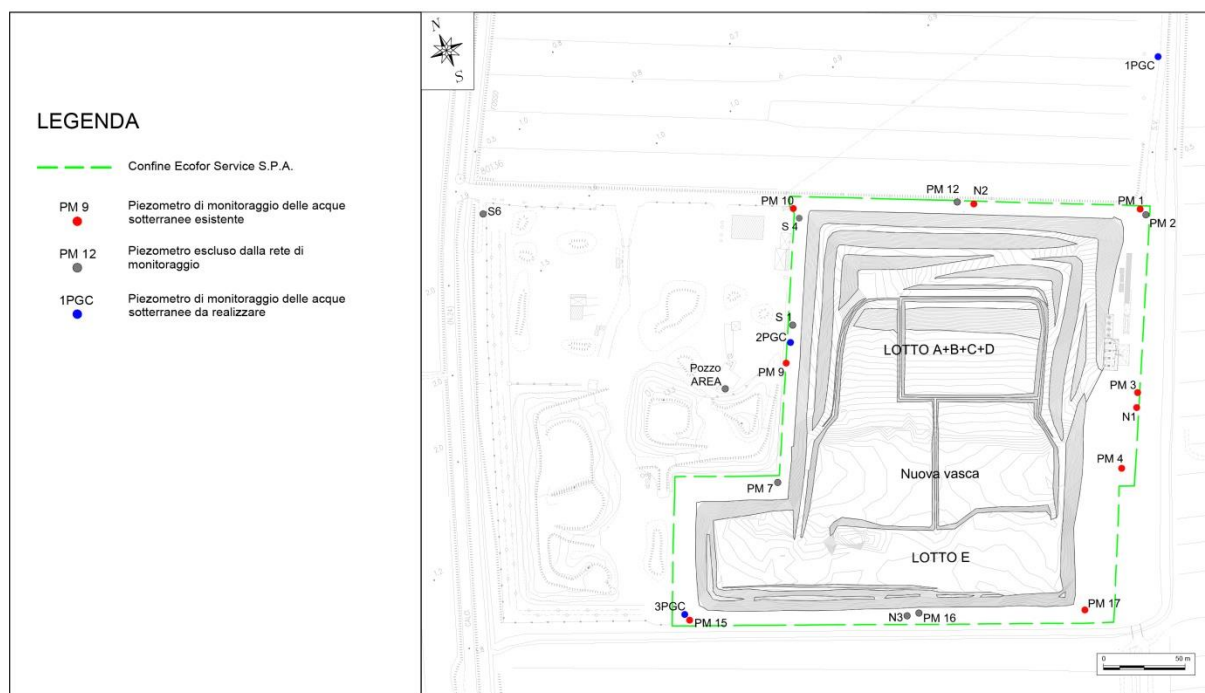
Planimetria con ubicazione piezometri di monitoraggio
